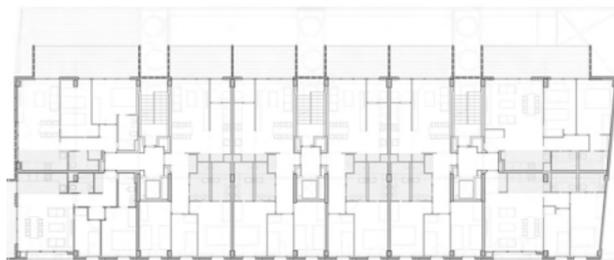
Plantas proyecto Fuente: Fermín Vázquez
